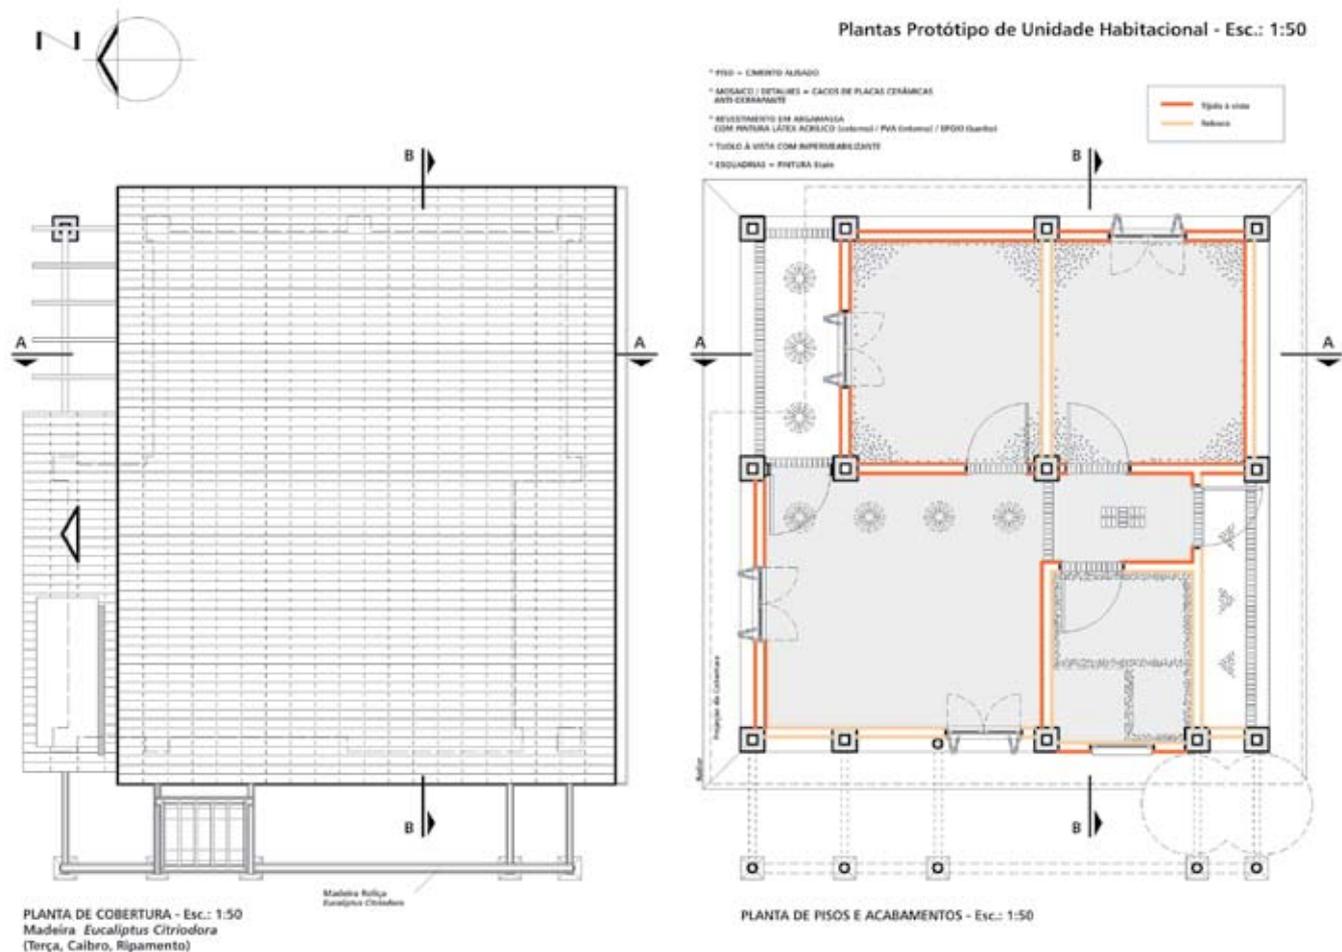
Planta da cobertura e detalhes de pisos e seu acabamento
